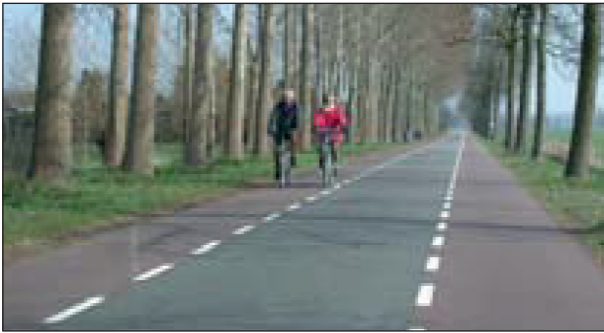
Flächenerschließende Straße mit einem einbahnigen Querschnitt (GOW II) (CROW, 2008)
